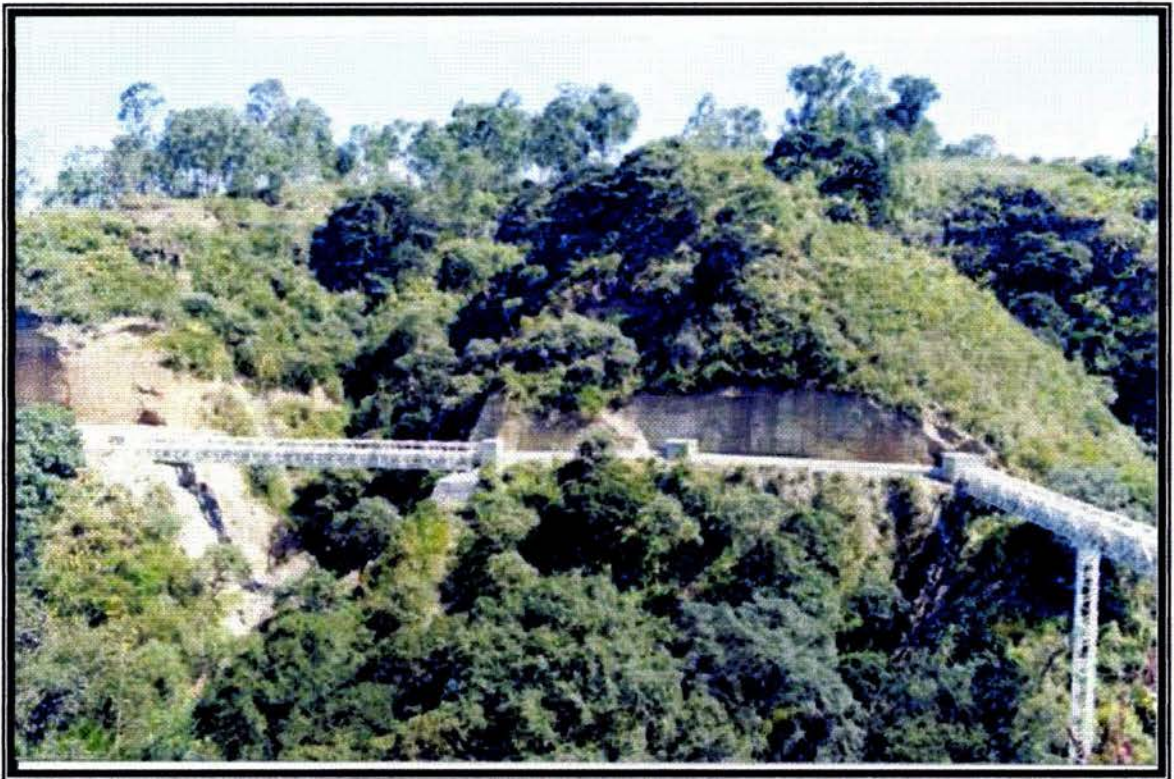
PUENTES DE ESTRUCTURA METÁLICA TOTALMENTE TERMINADOS, EN SU INTERIOR PUEDE APRECIARSE LA TUBERÍA DE 107 CM DE DIÁMETRO
